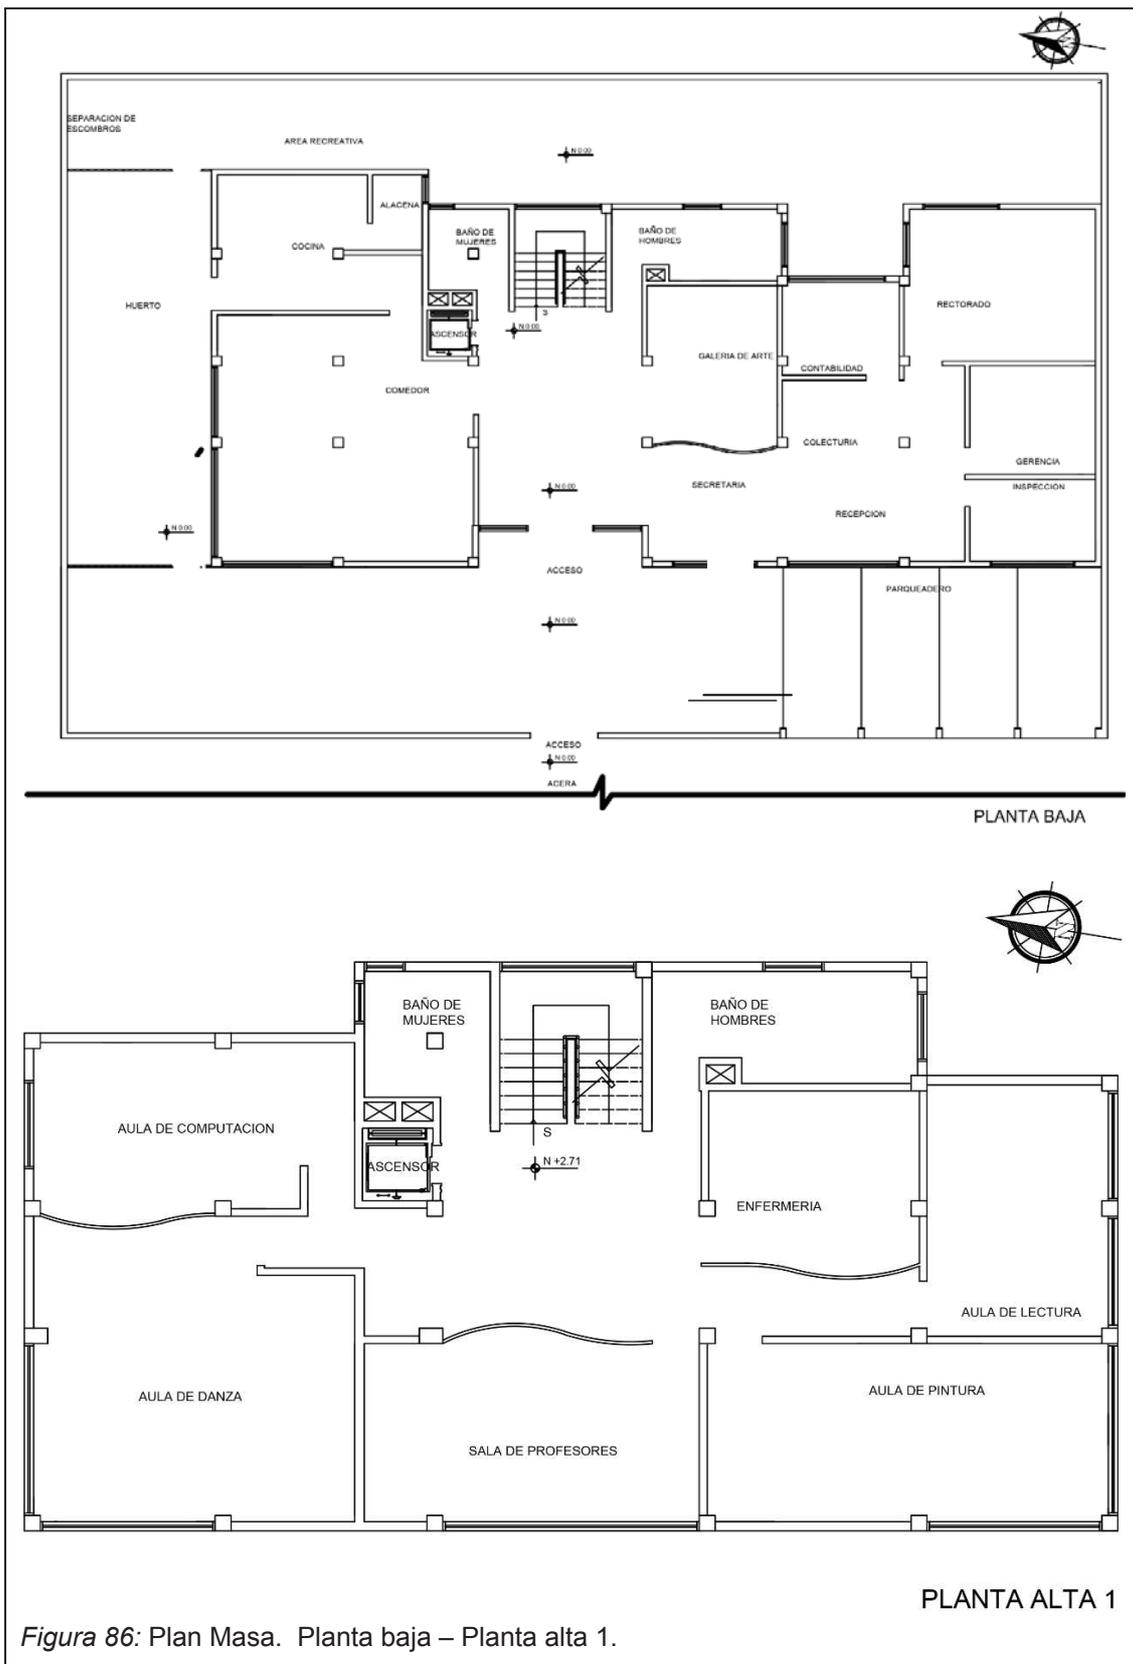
Plan Masa. Planta baja – Planta alta 1.
